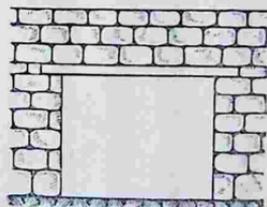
Бутовый столбчатый фундамент с железобетонной балкой.
